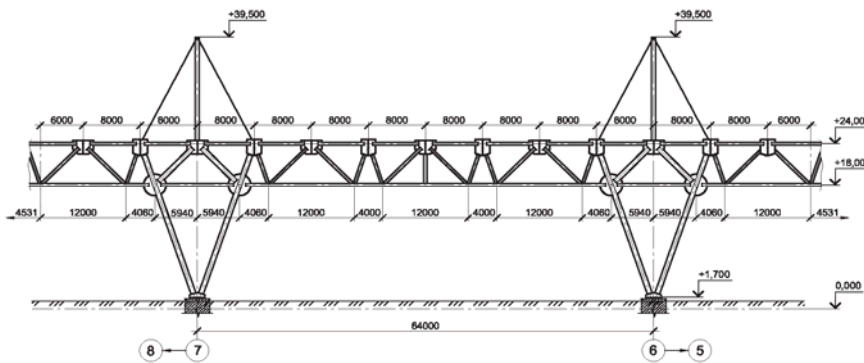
Фрагмент опорно-подстропильного контура стадиона ОСК «Металлист»
